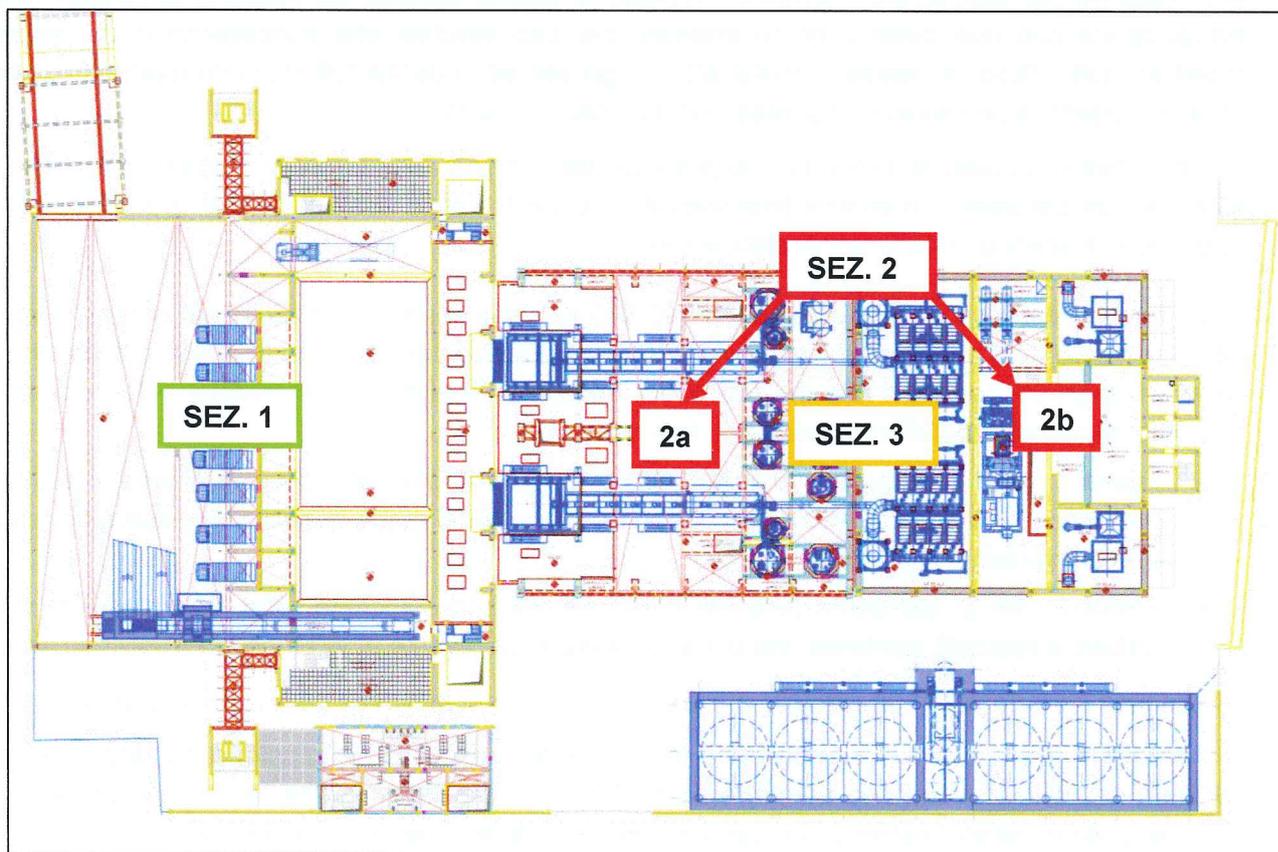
Layout impianto con indicazione delle principali sezioni impiantistiche
